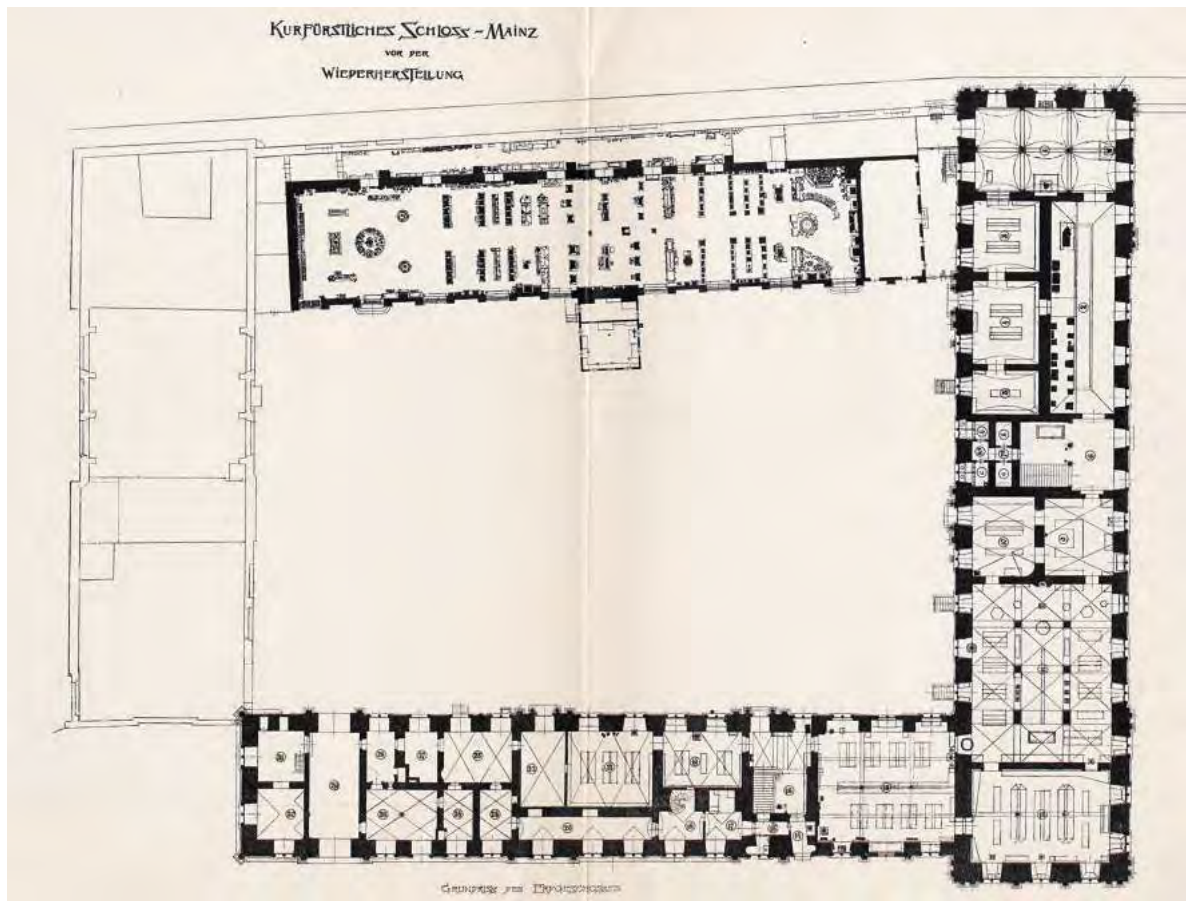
a Kurfürstliches Schloss, Grundriss des Erdgeschosses vor der Instandsetzung mit Eintragung der Vitrinen und Ausstellungsstücke.
